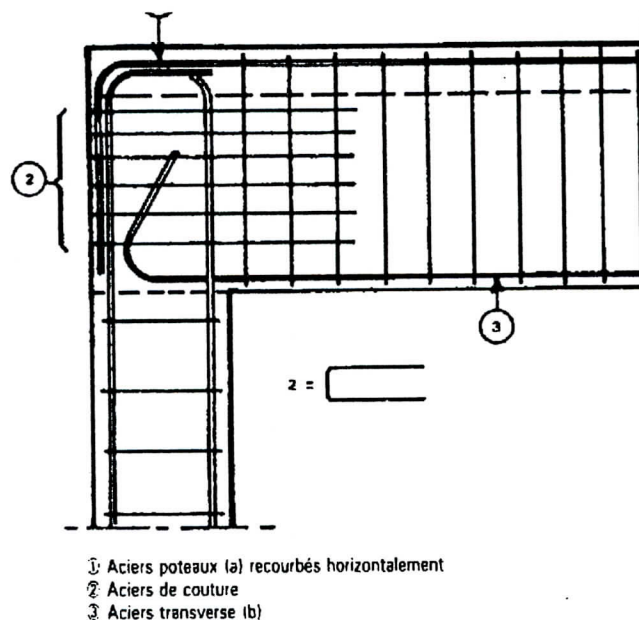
Disposition correcte : Liaison poteau - poutre [1]
